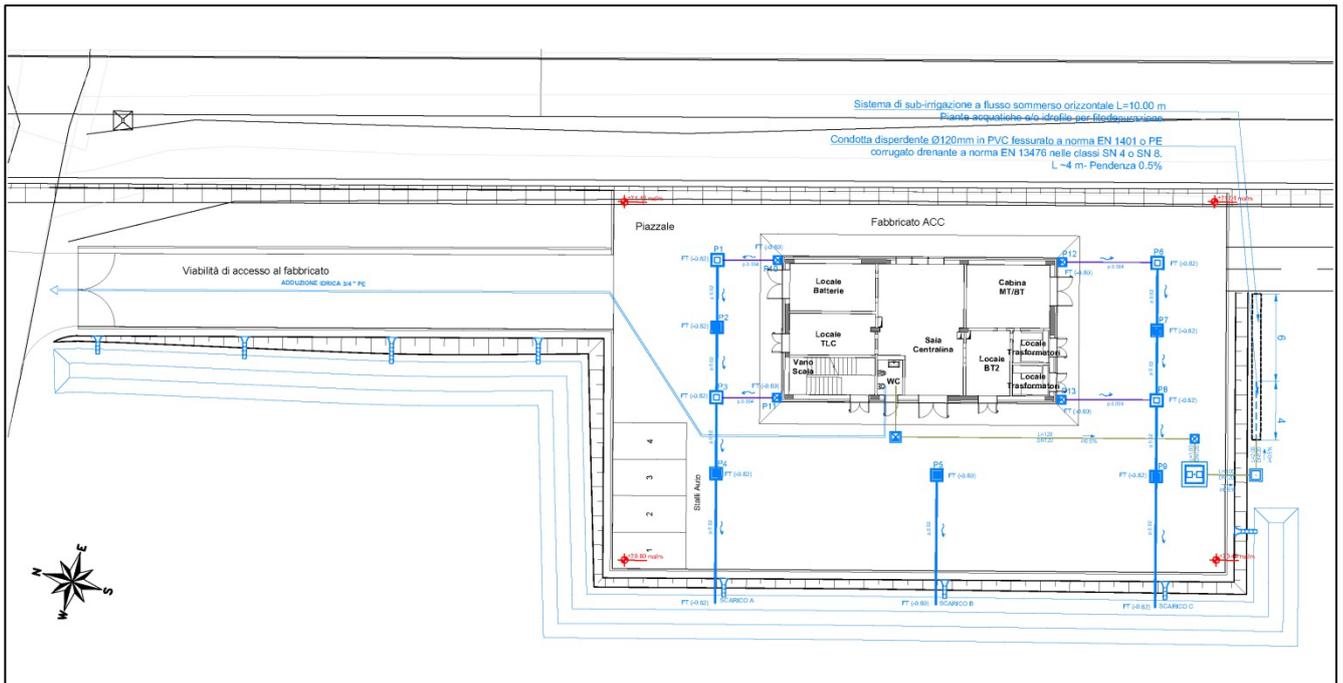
Schema di drenaggio del piazzale e della viabilità di accesso.
